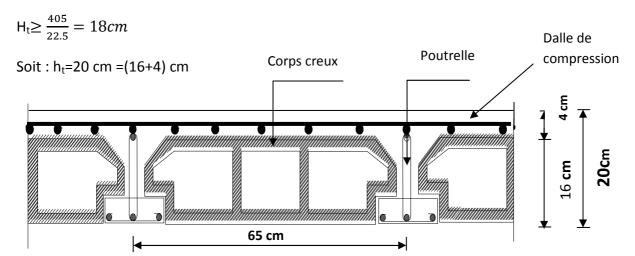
Coupe transversale d'un plancher en corps creux.
